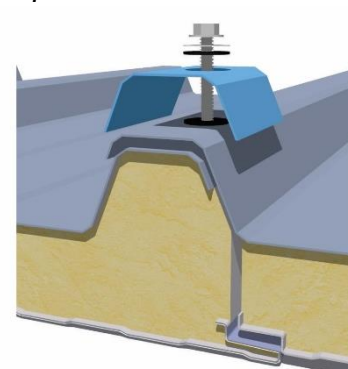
Detalle panel Maxiroof. Encastre – Solape de crestas.
